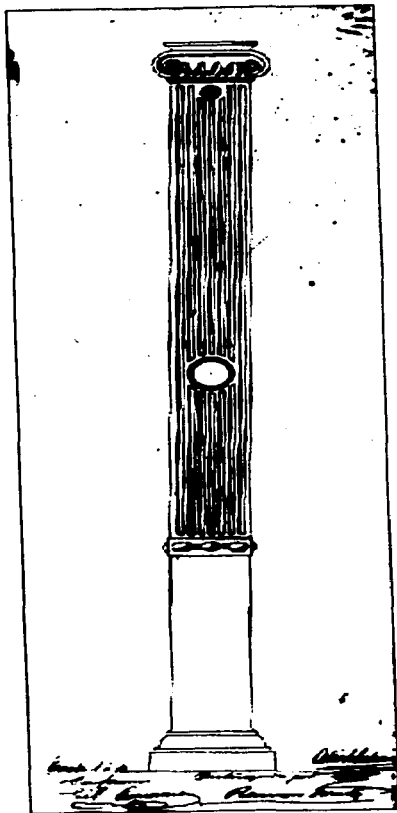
(01) Detalle de columna. Revestimiento de columnas metálicas interiores de los almacenes "La Exposición". Ingeniero Octaviano Cabrera. San Luis Potosí, S.L.P.
